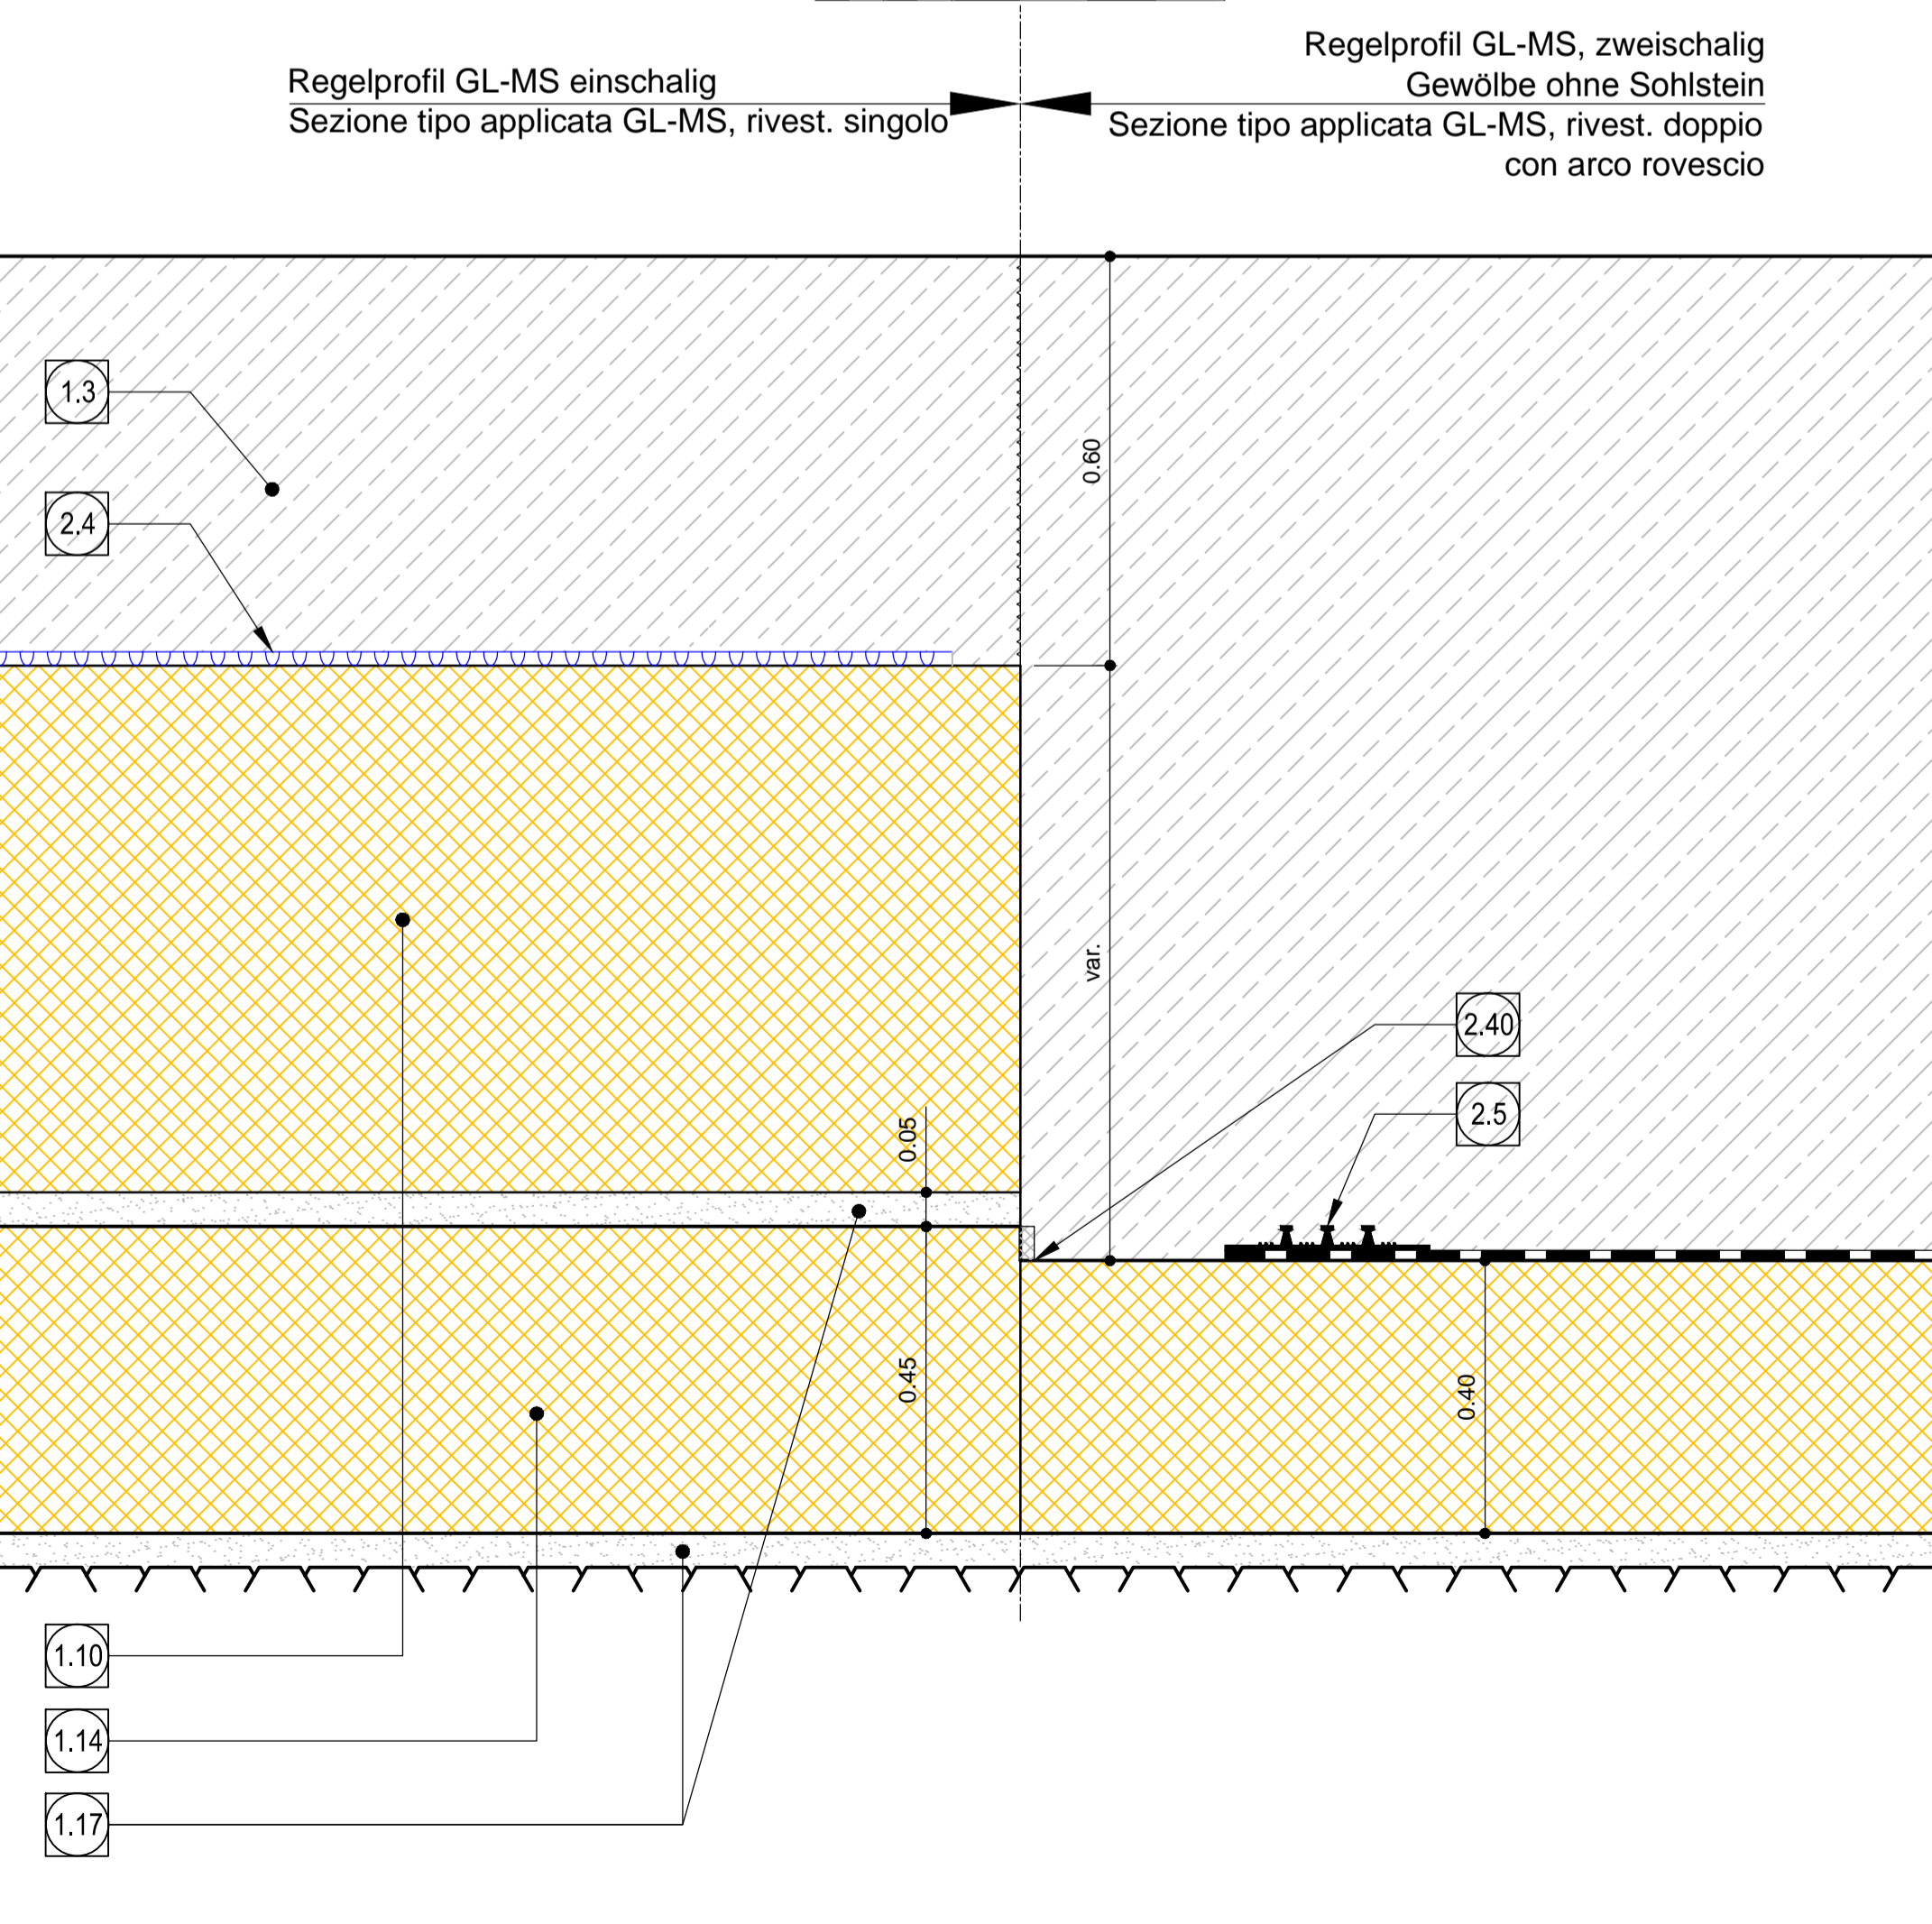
Blockfuge Innenschale / Dettaglio 1: giunto tra i blocchi, rivestimento definitivo
